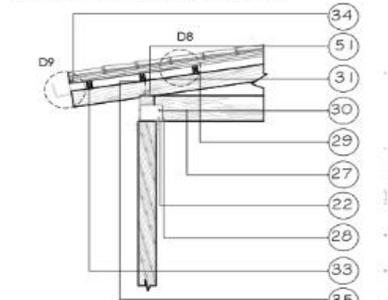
Detalle 7 (Cubierta)-Esc:1/50
